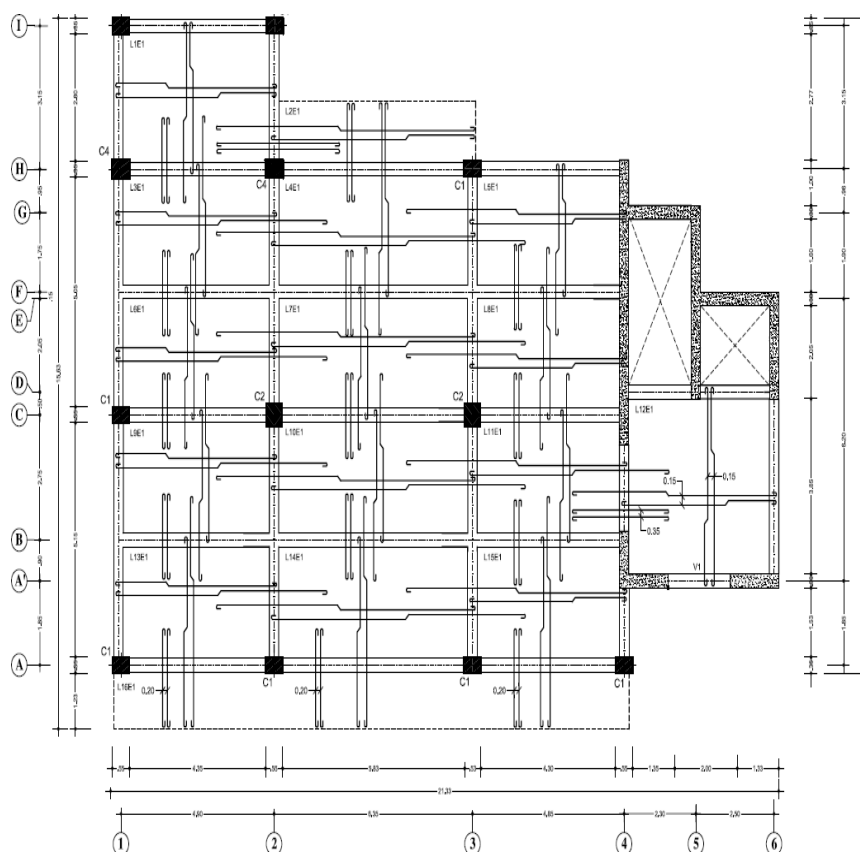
Planta Estructural de Techo Edificio Anexo Banco Ademi
